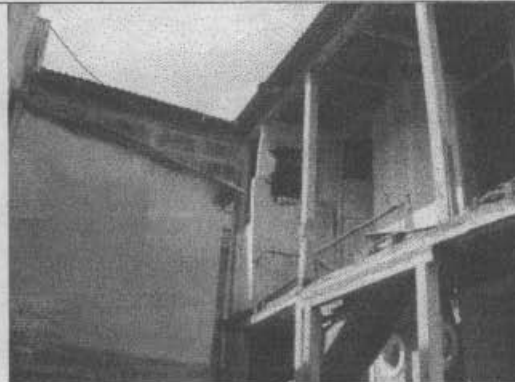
Construcción en la parte posterior de la edificación que se encuentra en mal estado.
